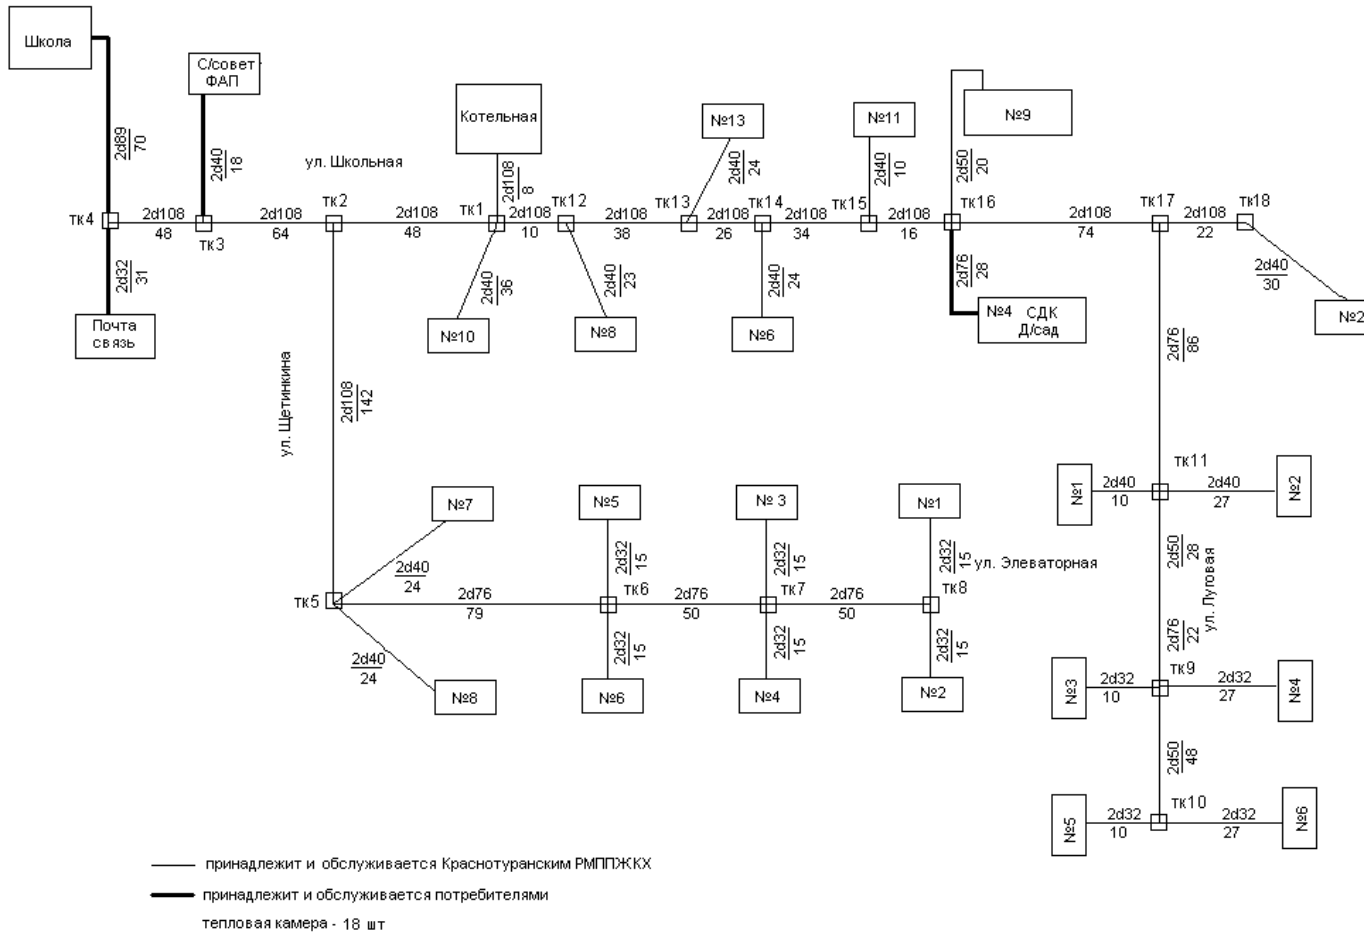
Схема теплоснабжения от муниципальной котельной
